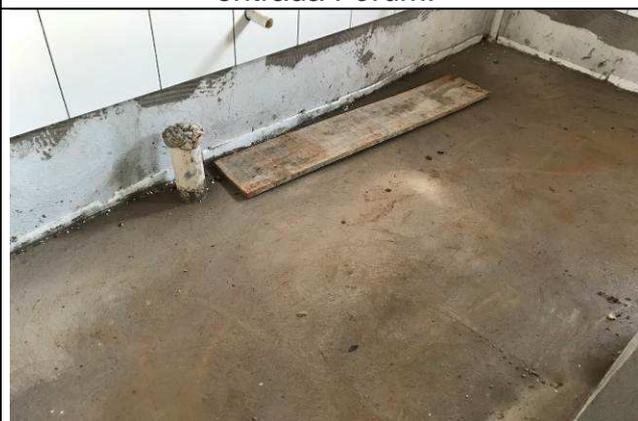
C: Contrapiso concretado - banheiros do Fórum.
